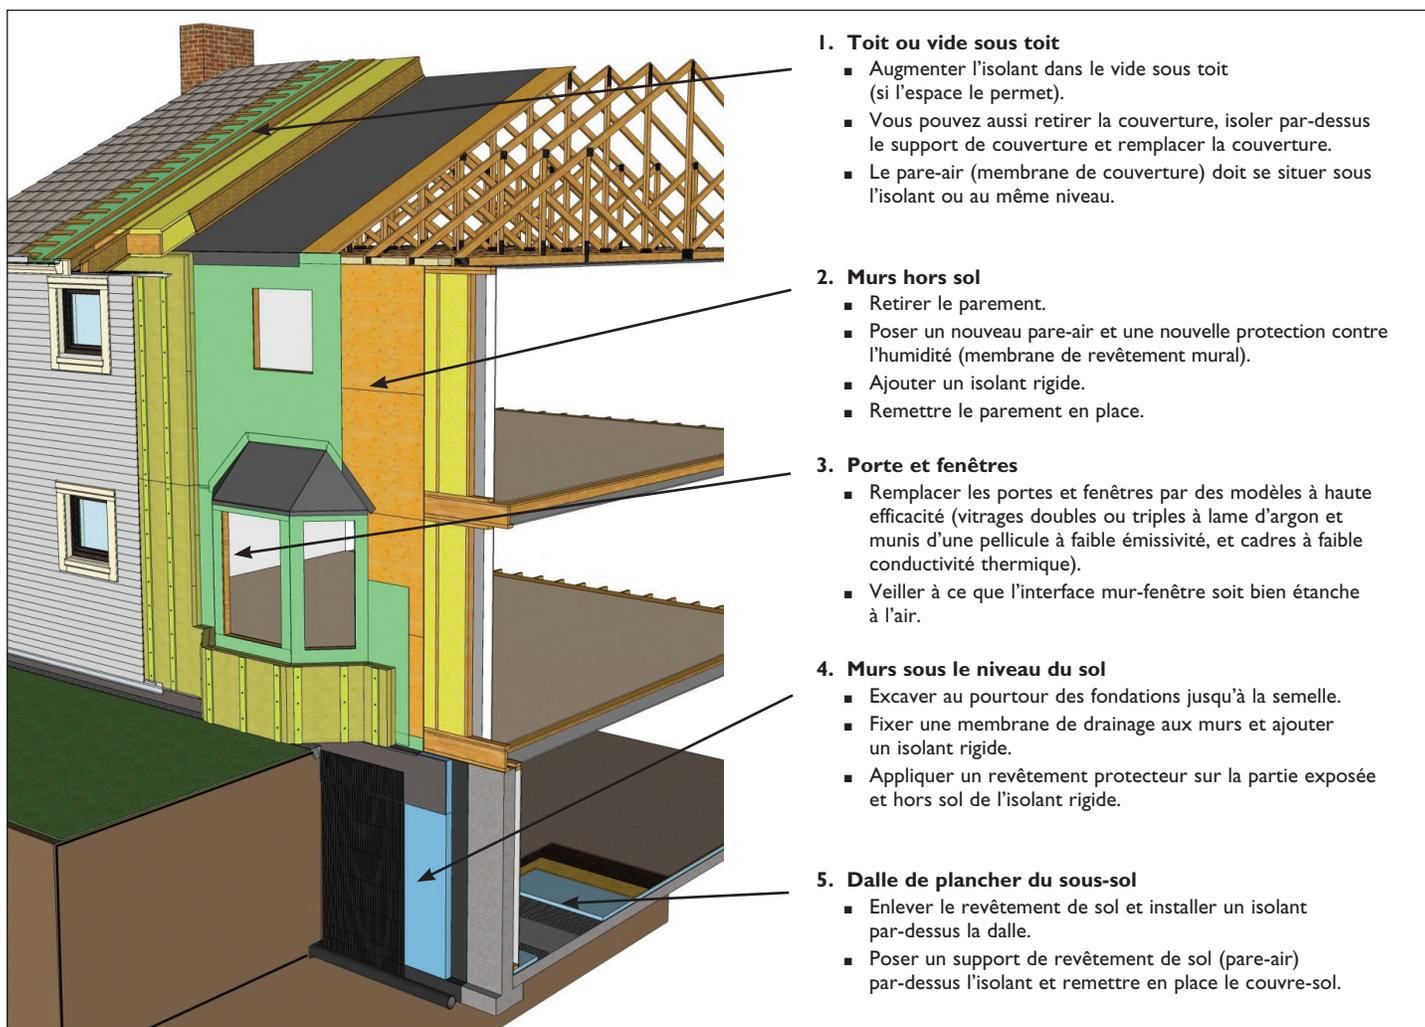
Amélioration de l'isolation par l'extérieur : coupe à travers le toit, les murs et les planchers (après les travaux)
